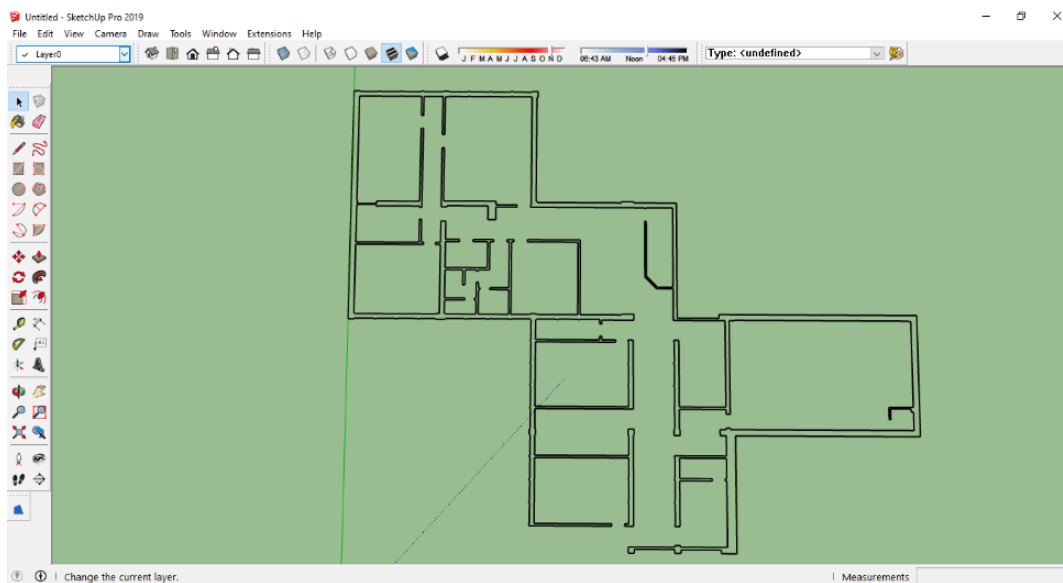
Importação da planta em 2D para o SketchUp.
